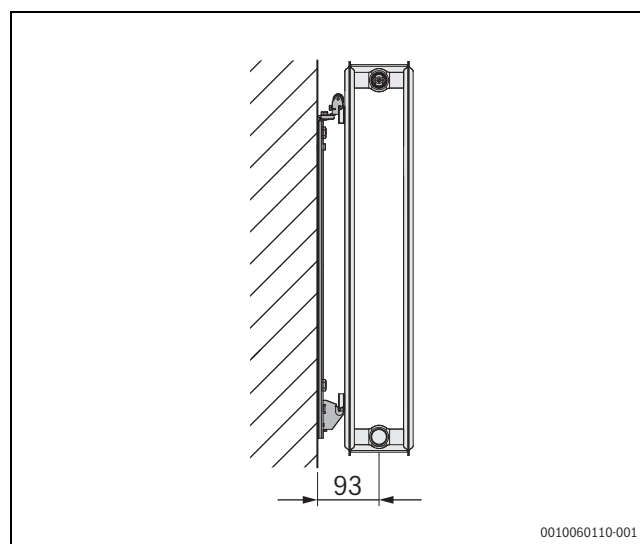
Heizkörperkonsole Typ 20 für VC-, VCM-, C-Plan/Profil.2
